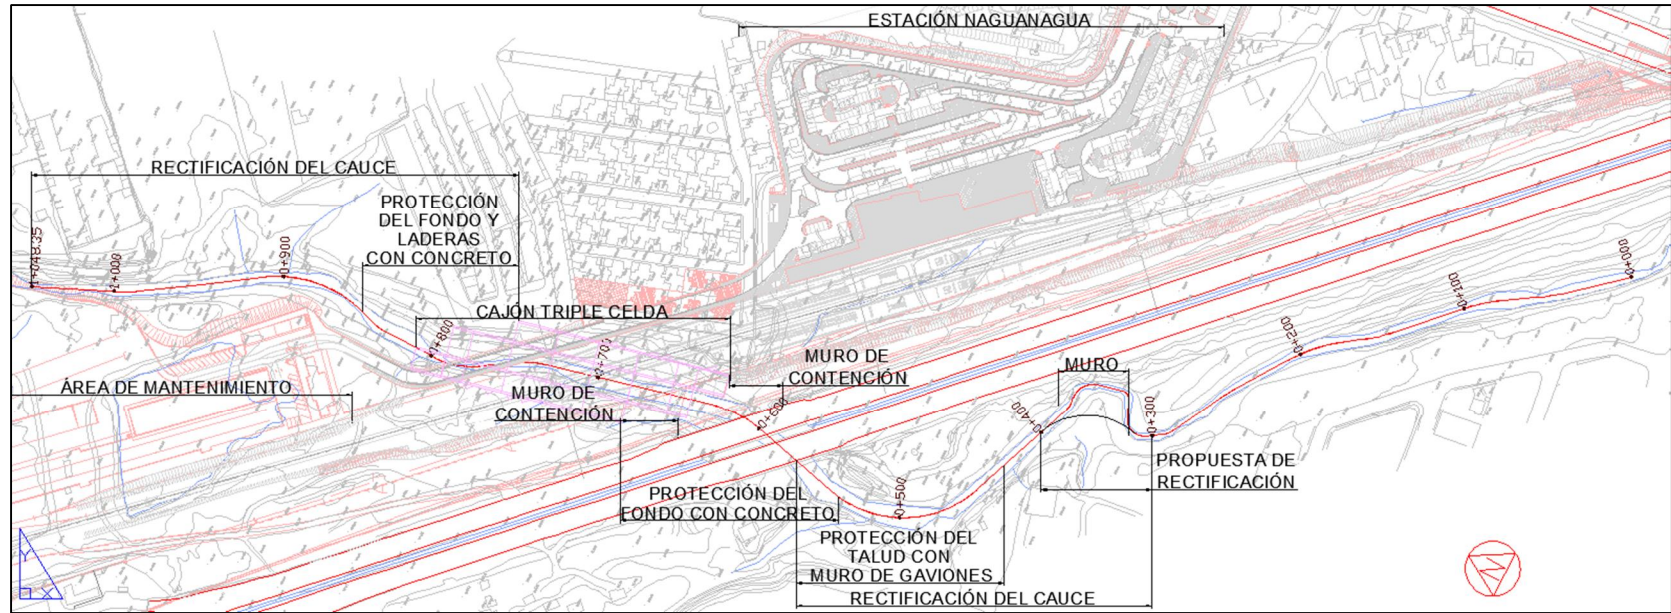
Ubicación en planta del muro de contención y la propuesta de rectificación. Nota. Elaboración de los autores.
